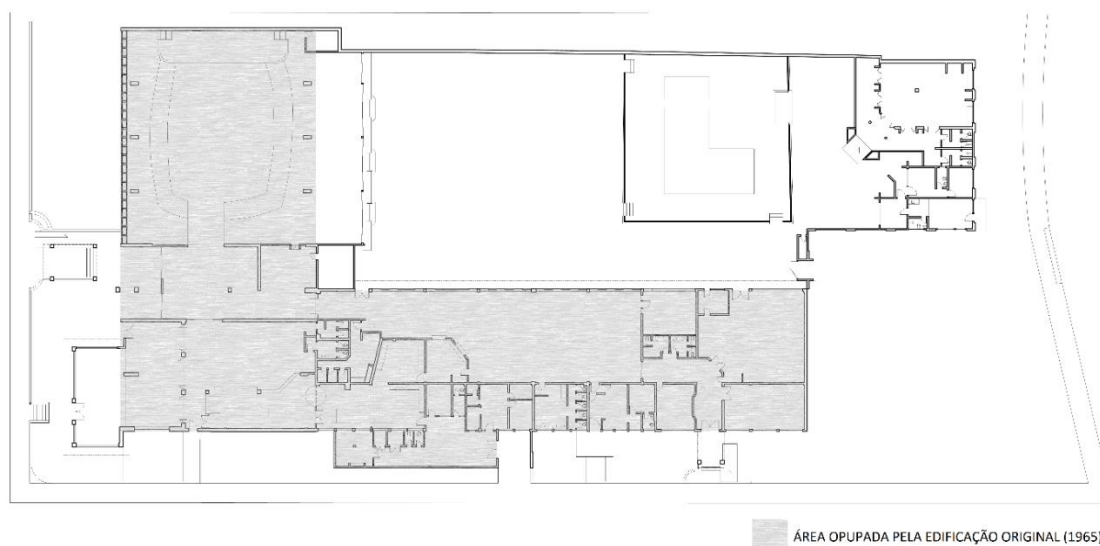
Planta da sede central da SABA. Projeto de reforma e ampliação, 1993.
